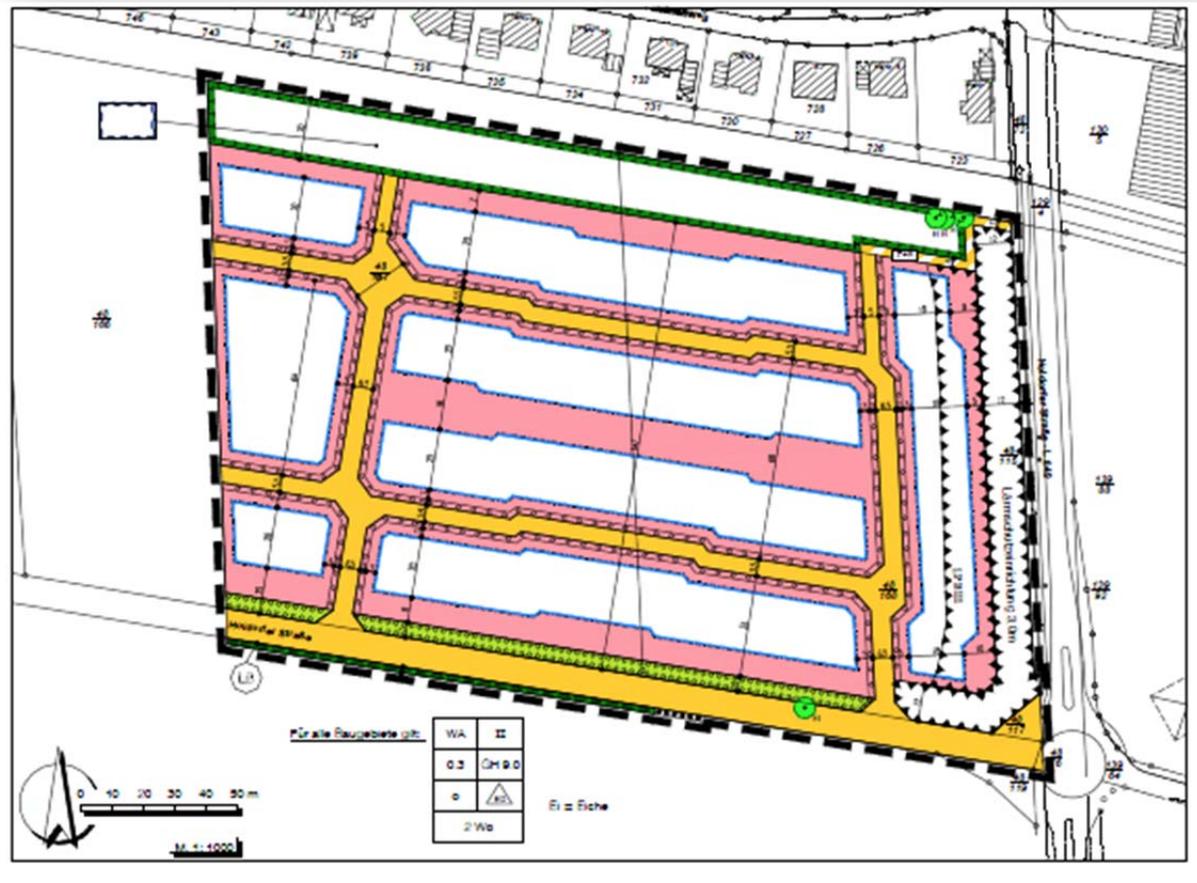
Plangebiet (Entwurf zur öffentlichen Auslegung), pk plankontor städtebau
